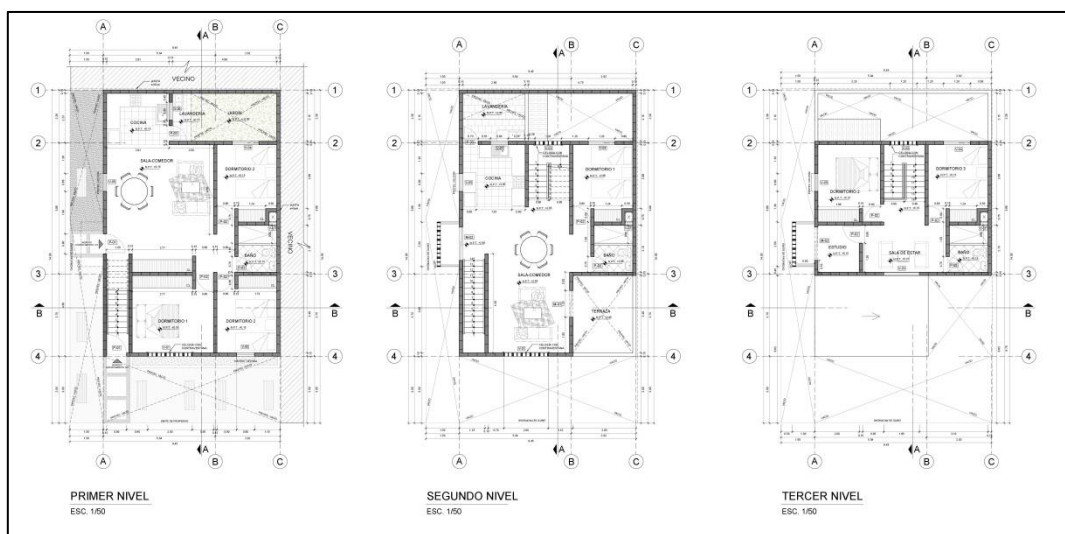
Vivienda bifamiliar entre lotes
